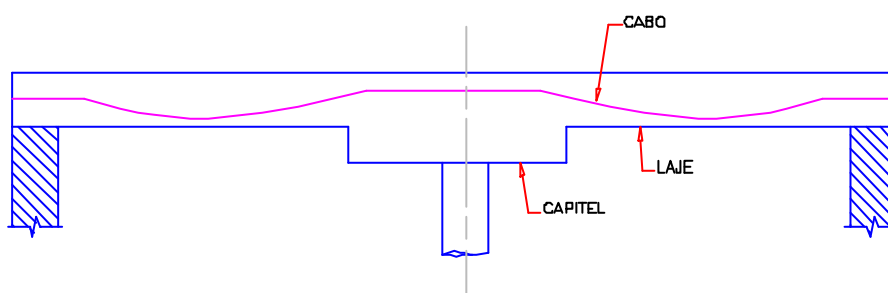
Laje com Capitel no Apoio Central
